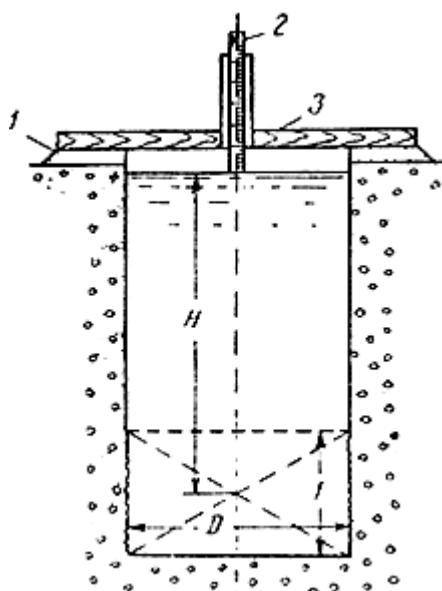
Схема определения удельного водопоглощения бетона (4-й ярус, 42-я секция)
